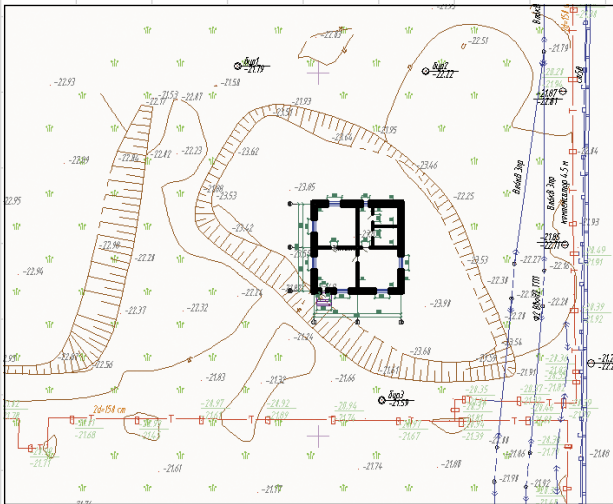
Топография и план первого этажа совмещены на листе генерального плана
